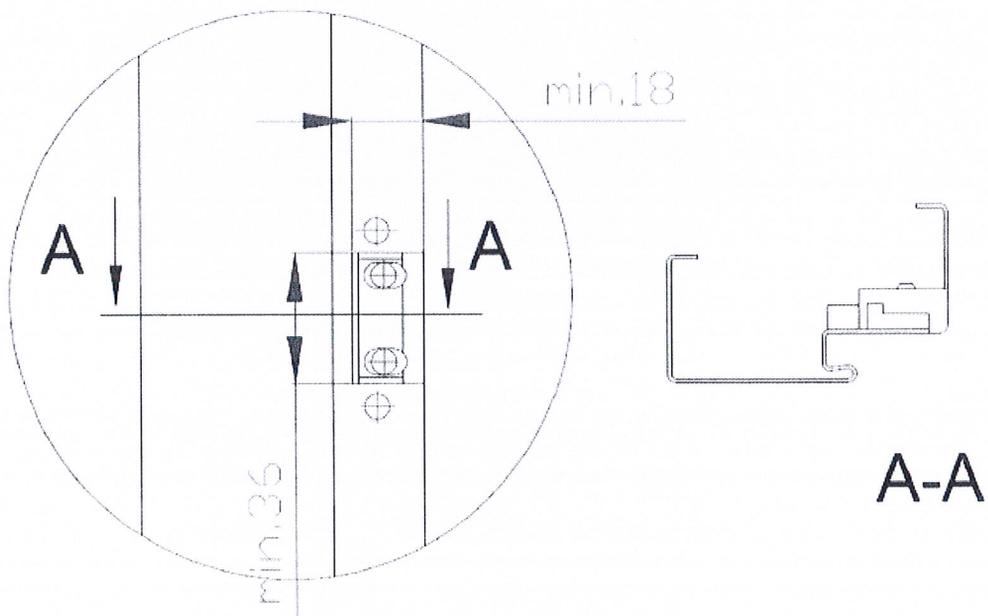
Einstellbare Befestigungshaken und E-Öffner für Stahlürrahmen
